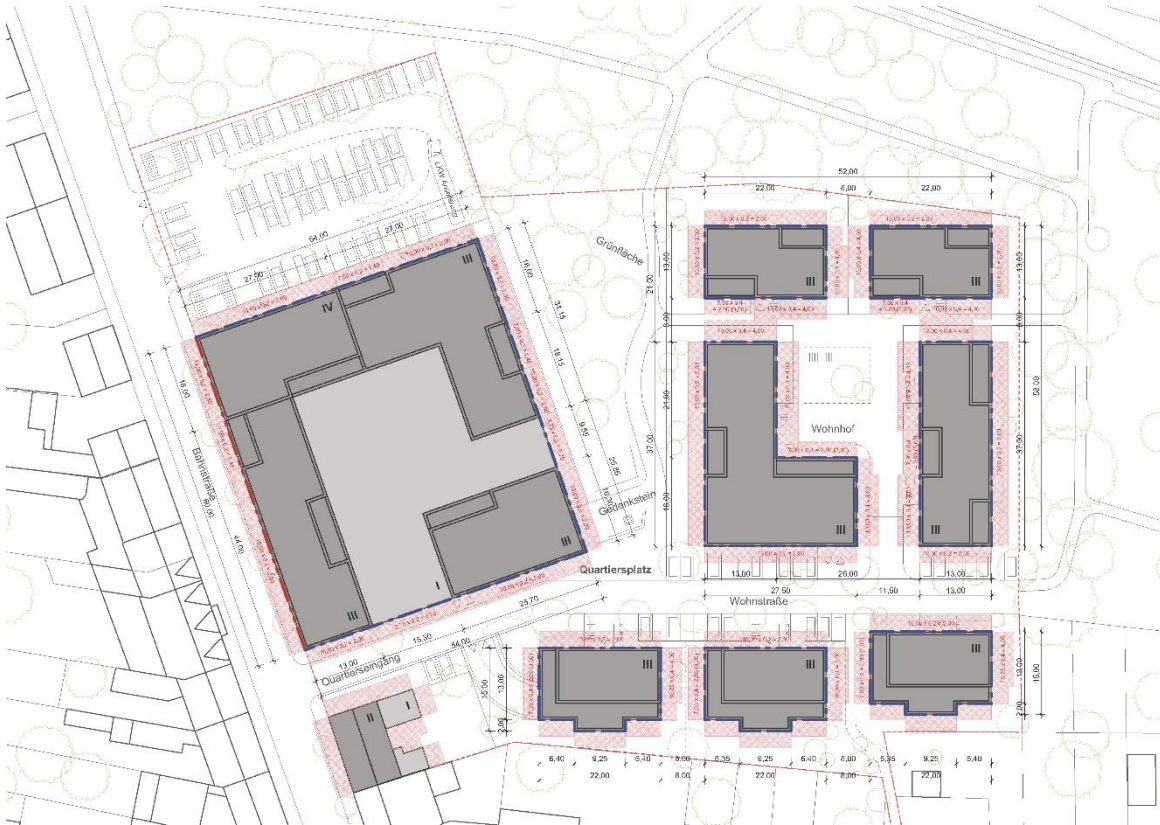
Rahmenplanung | Abstandsflächen © LECKE ARCHITEKTEN
